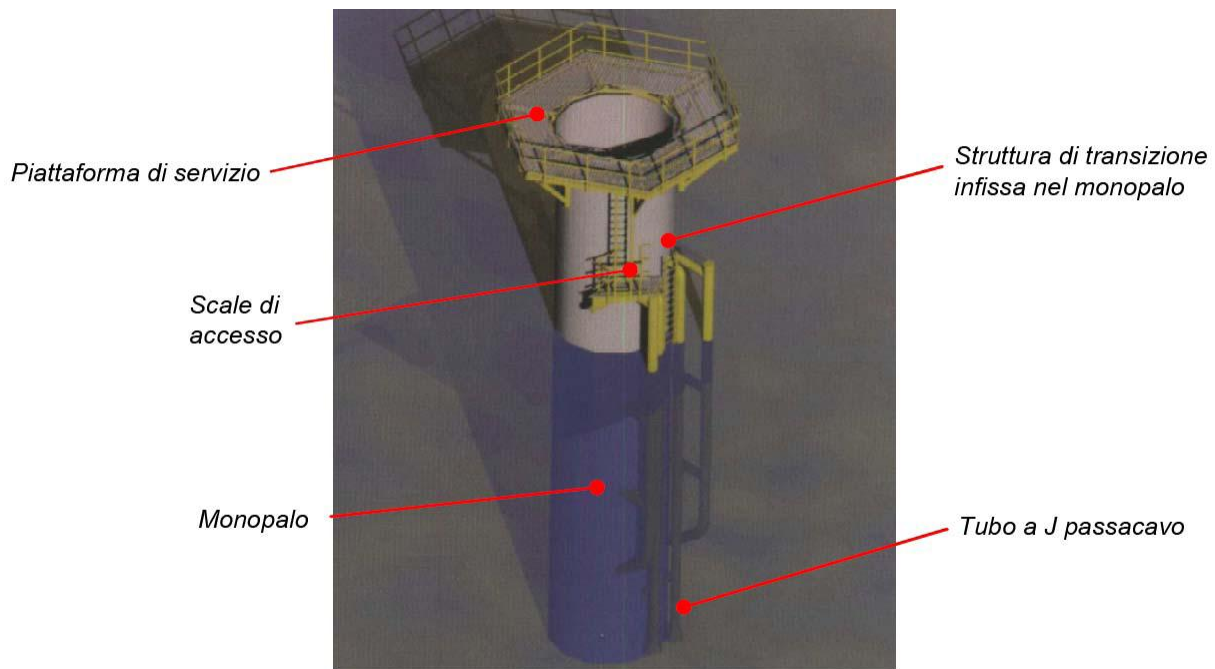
Schema descrittivo della fondazione e della struttura di transizione.
